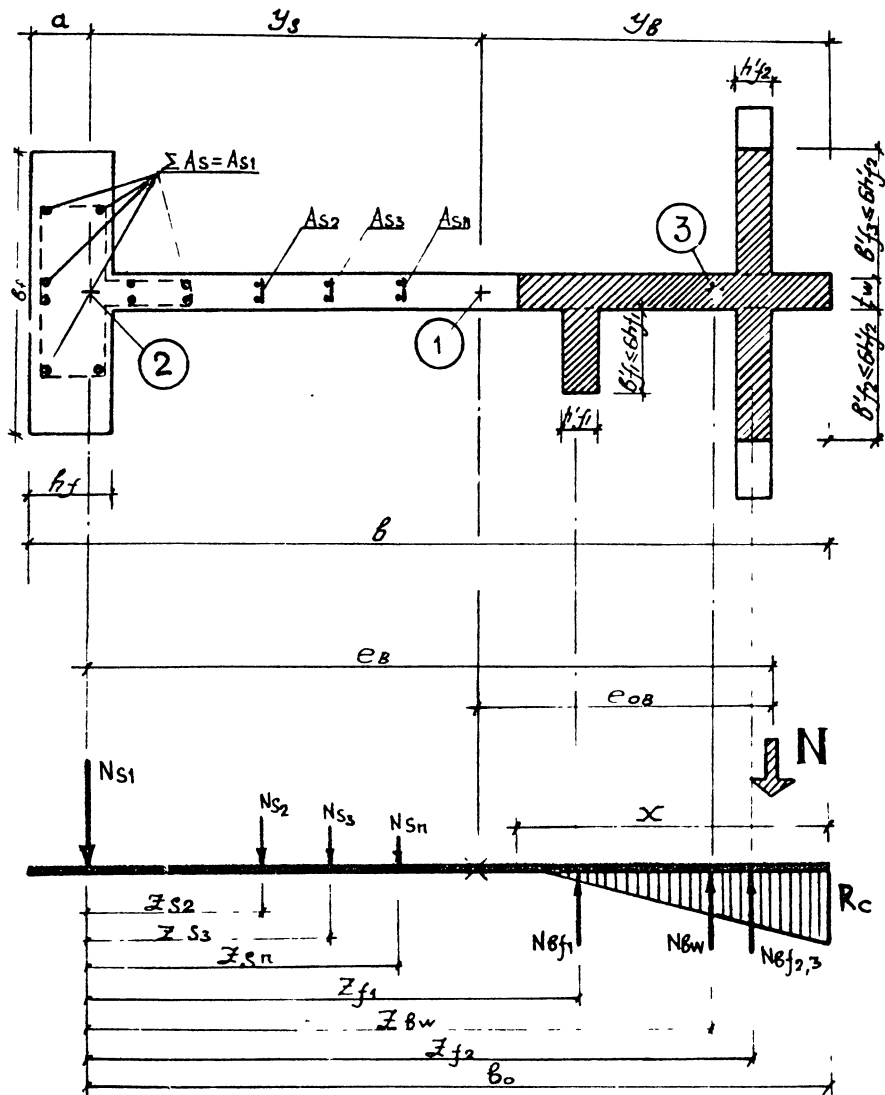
Схема расчета горизонтального сечения несущего стенового элемента при внецентренном сжатии (общий случай):
